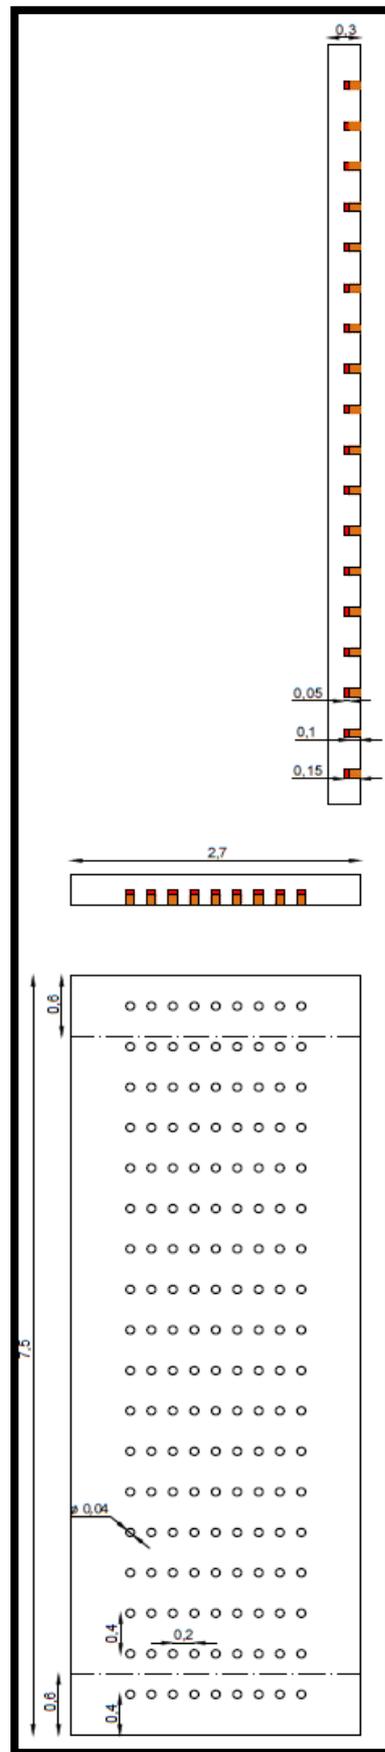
Alzado, perfil y planta del “Muro de carga Exterior”.
